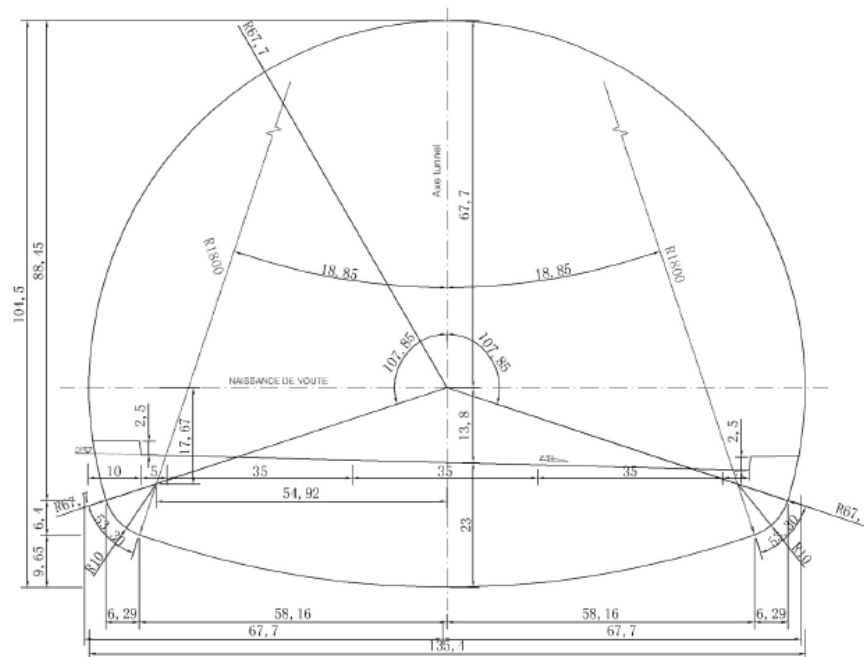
profil en travers de l'intrados du tunnel [3]
